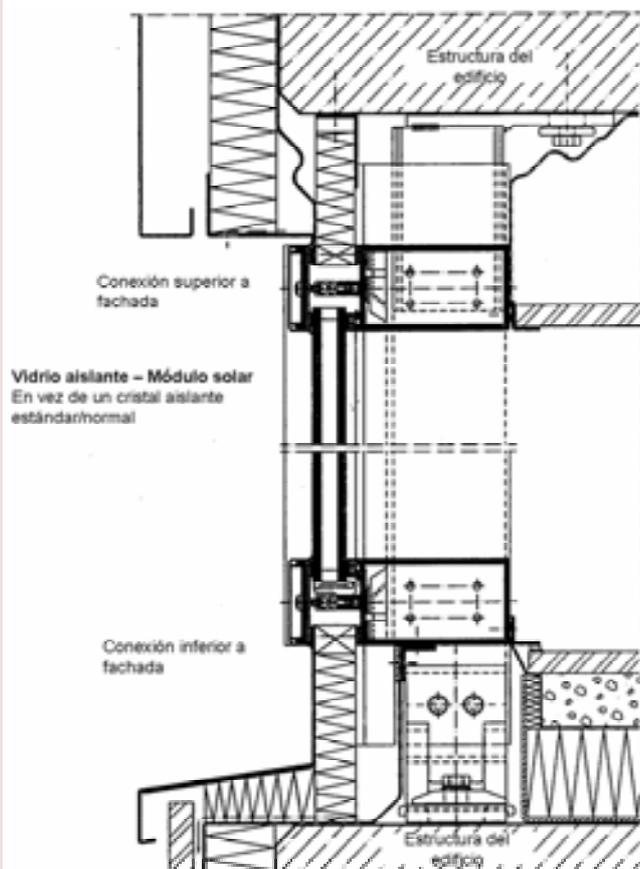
Esquema de una fachada del tipo Muro Cortina.
